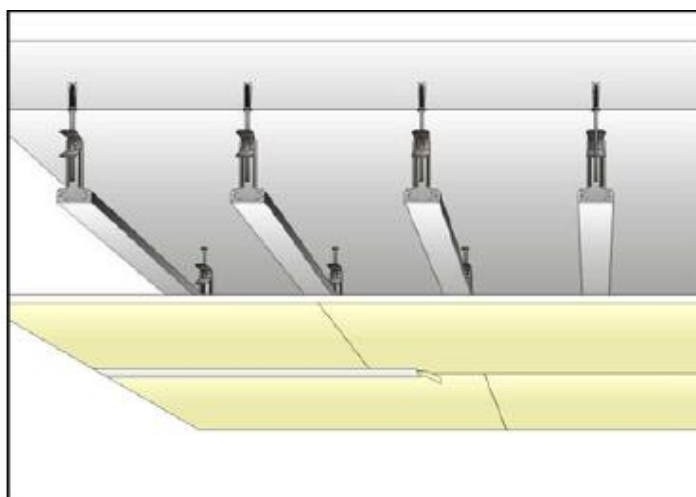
Placas em gesso acartonado fixadas com perfis metálicos (BARROS FILHO, R.M, 2010)
